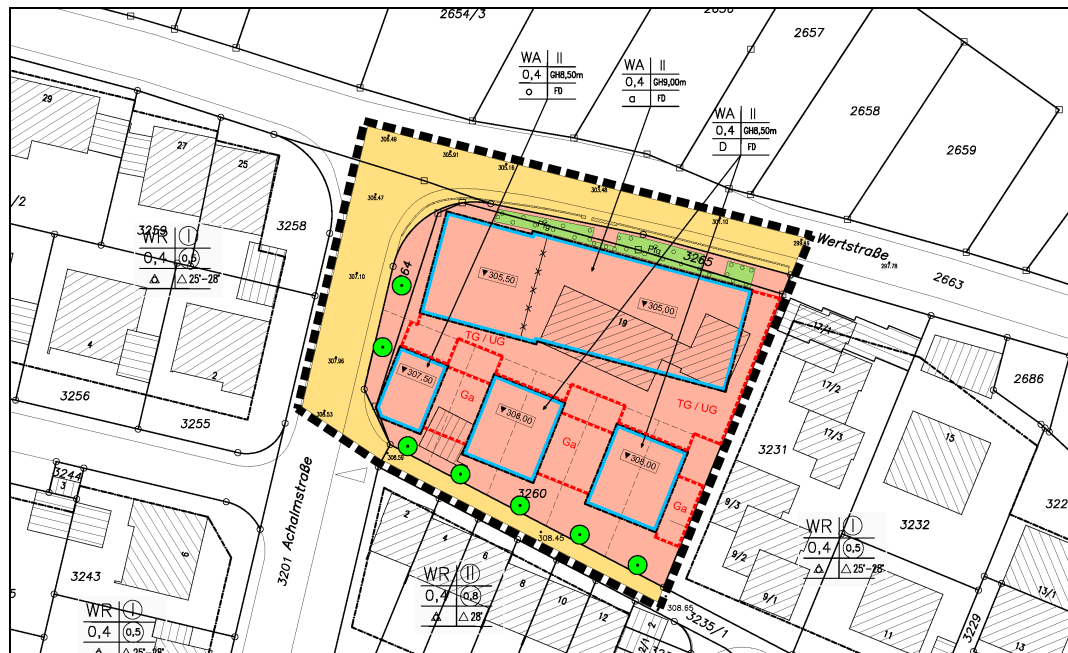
Bebauungsplan "Wertstraße I - 6. Änderung" vom 18.10.2018
